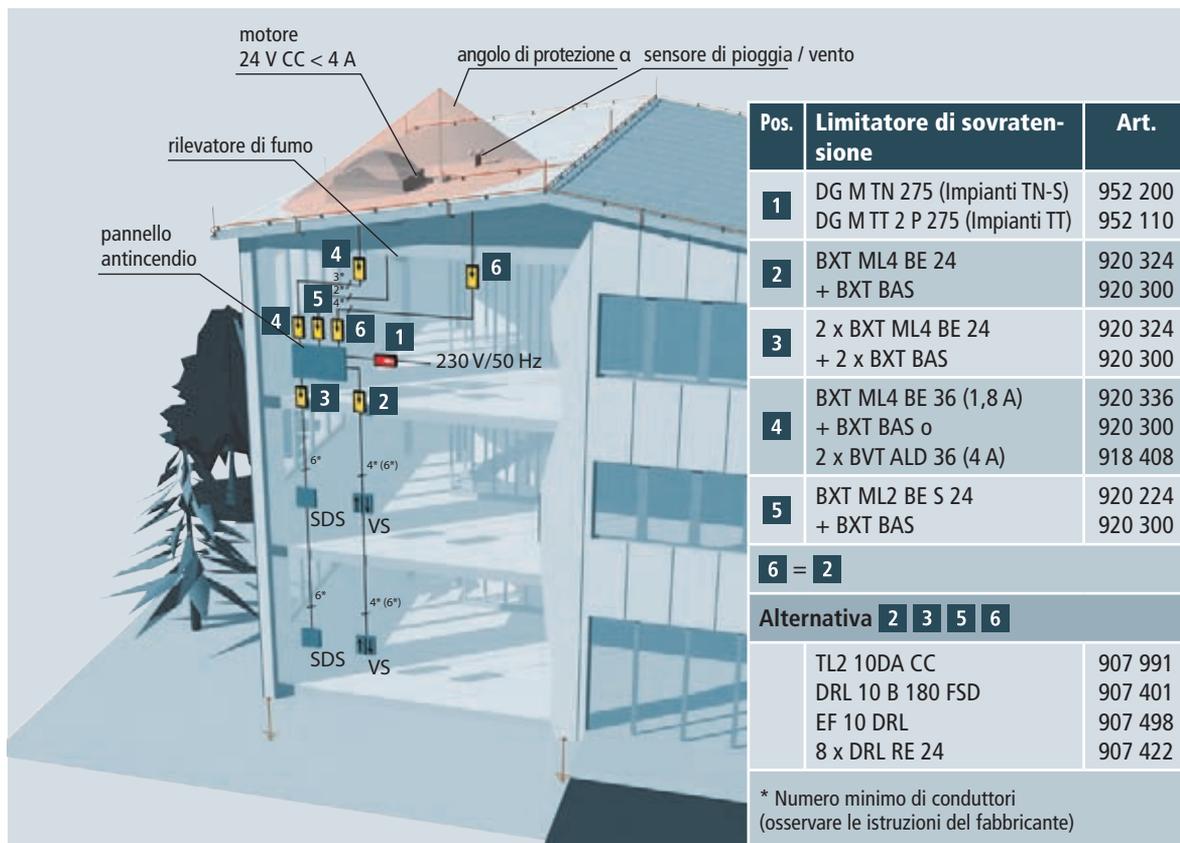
Lucernario situato nel volume protetto di un'asta di captazione sul tetto metallico di una struttura dotata di calata metallica (telaio in acciaio, cemento armato con armatura interconnessa o facciata metallica collegata a terra)
